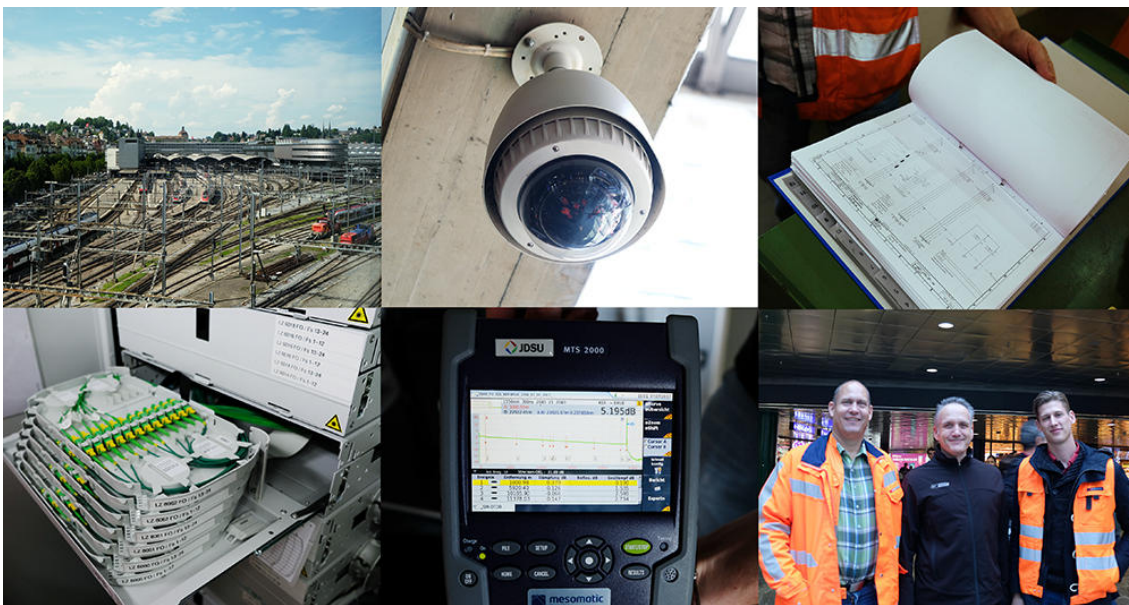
obere Reihe v.l.n.r.: Blick vom Stellwerk auf den Bahnhof in Luzern, 360-Grad-Kamera im Bahnhofsgebäude, Handbuch zur Dokumentation für Elektroinstallationen; untere Reihe v.l.n.r.: Netzwerkinstallation mit gespleissten Glasfaserkabeln, Modularer Handtester zur Installation, Inbetriebnahme und Wartung von Glasfasern, Teamleiter Telecom Luzern (Mitte) mit zwei Mitarbeitenden
